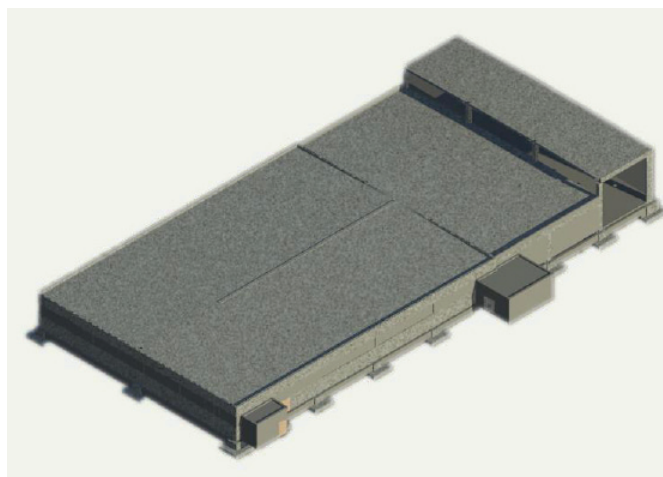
vista prospettica dalla alto del modello Bim della struttura
